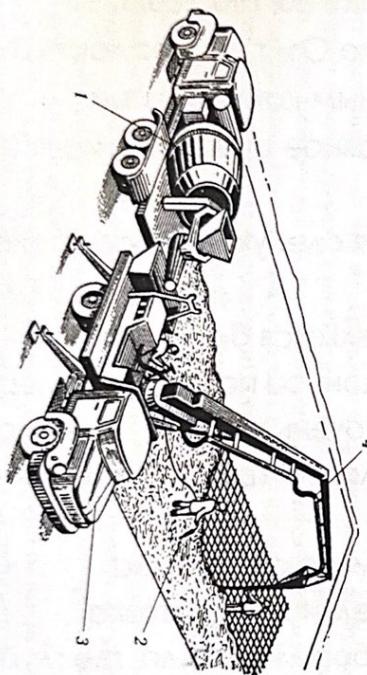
Укладка бетонной смеси автобетономаслами:
